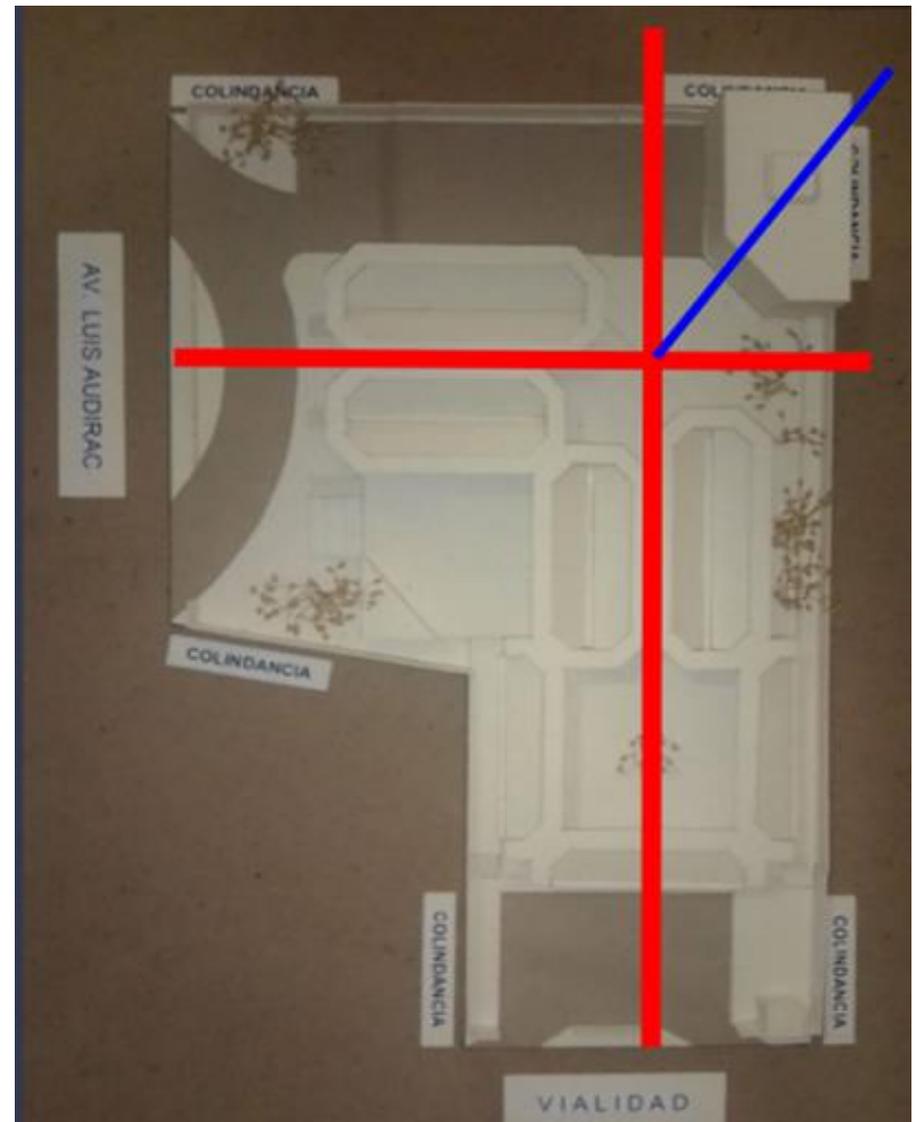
Fuente: Elaboración propia con base en maqueta del proyecto propuesto (Ejes compositivos)
